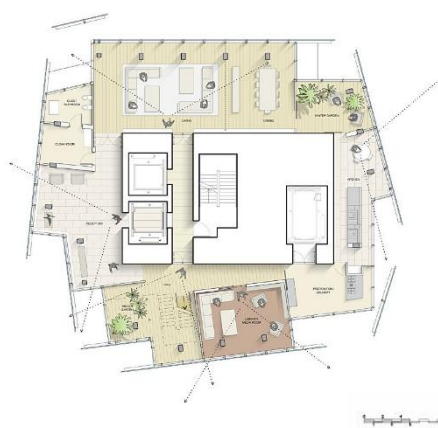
plan de 2<sup>ème</sup> étage d'un appartement en duplex
